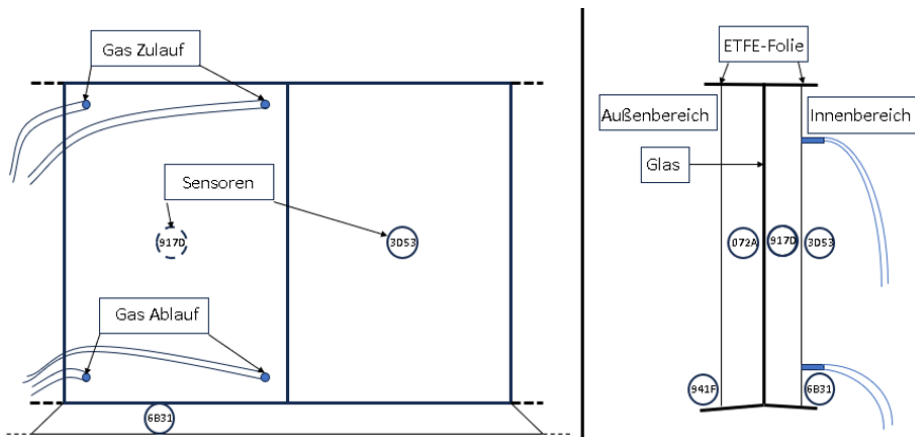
Light-Light-Roof-Modul (Aufbau: Folie-Glas-Folie) mit installierter Sensorik. Darstellung der Frontansicht (links) und des Querschnitts (rechts).
